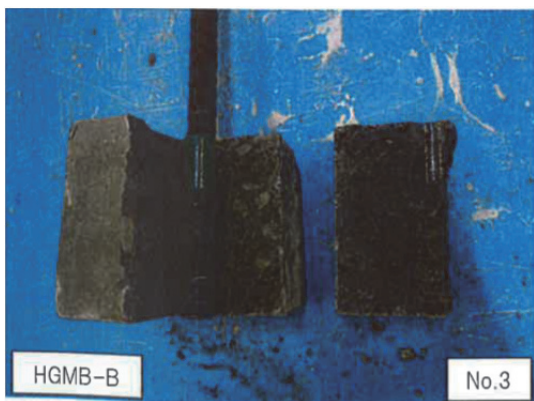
鉄筋とコンクリートとの付着強度試験試験後供試体状況
